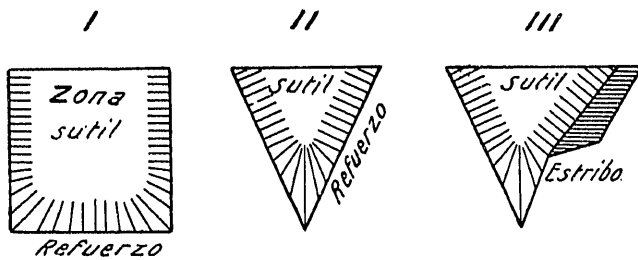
ª Esquema de las diversas secciones transversales de un cauce.
